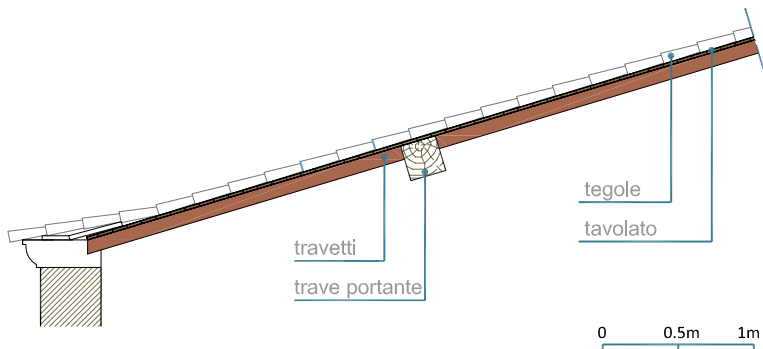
Sezioni copertura tradizionale a doppia orditura.
